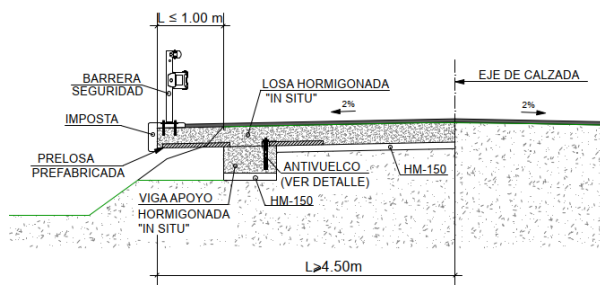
Voladizo de losa < 1 m con cimentación directa.
